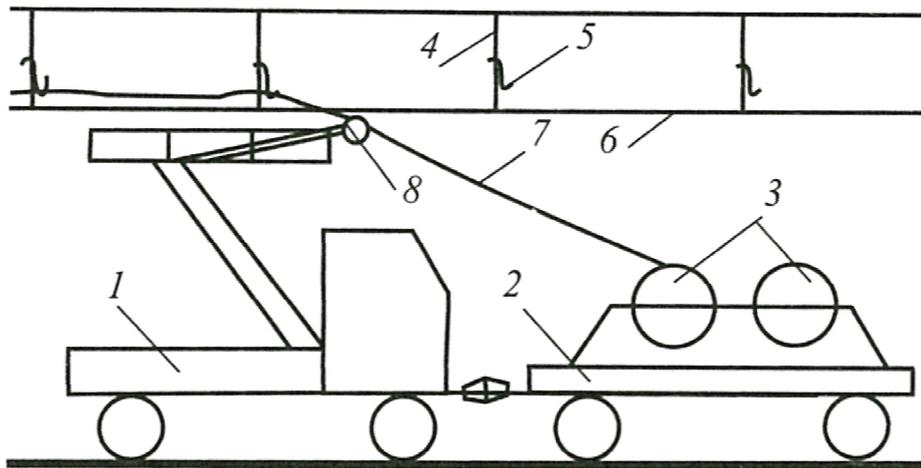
Схема подкатки контактного провода: 1 — автомотриса; 2 — раскаточная платформа; 3 — барабаны с контактным проводом; 4 — вертикальные струны; 5 — монтажные крючья; 6 — рабочий контактный провод; 7 — раскатываемый контактный провод; 8 — направляющая стрела с роликом
